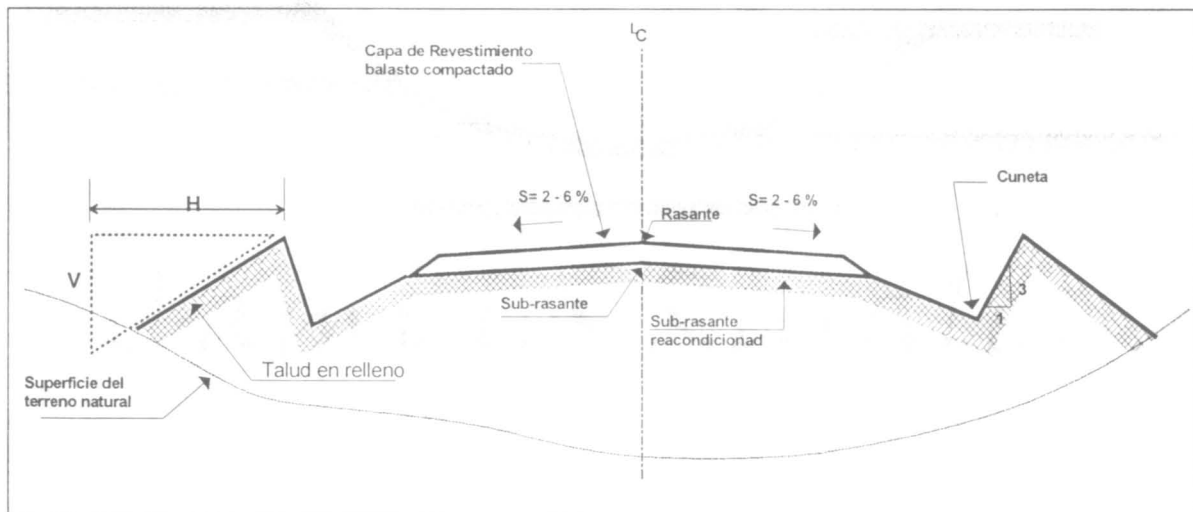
Sección de Relleno en Terreno Plano o Lomerío Suave
